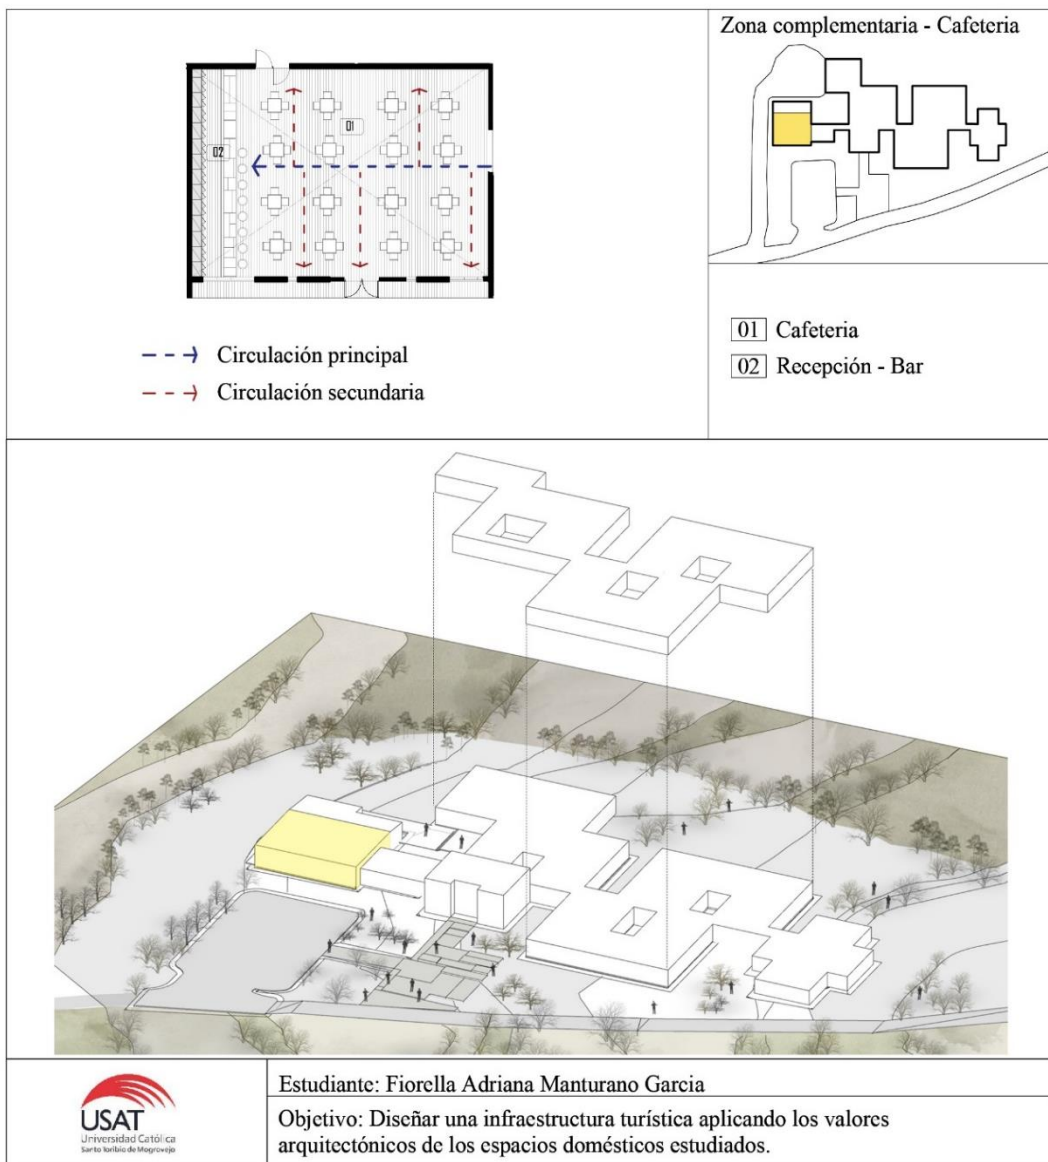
Zona Complementaria Cafeteria Plano / Axonometría (Primer Nivel). Fuente: Elaboración Propia
